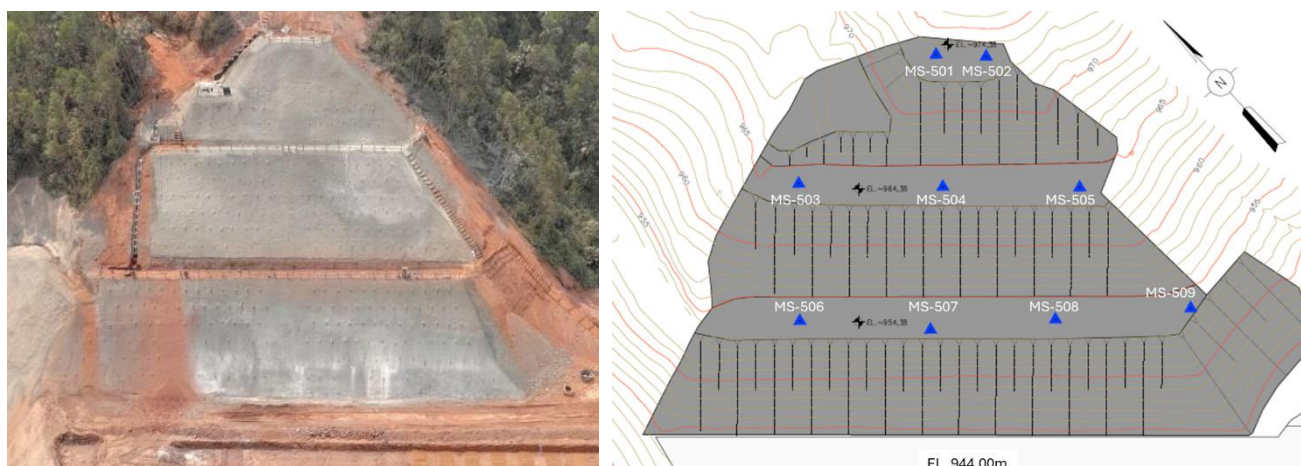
Vista aérea da contenção em fase final de construção (à esquerda) e locação em planta da instrumentação da contenção (à direita).
